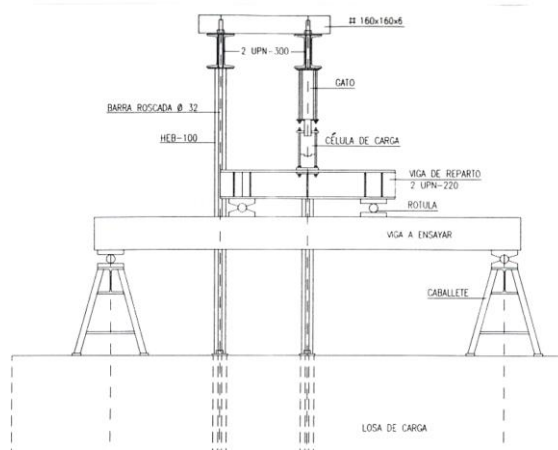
Esquema de ensayo para vigas bajo carga sostenida [SERR94]
